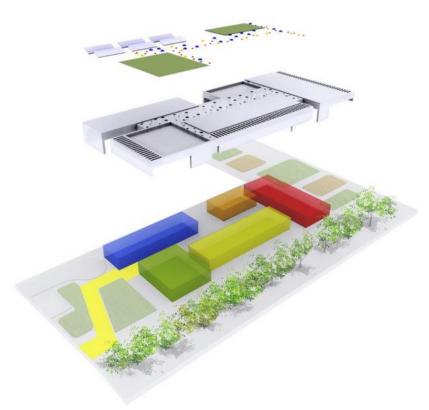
Planta explotada. Fuente ArchDaily www.archdaily.mx
